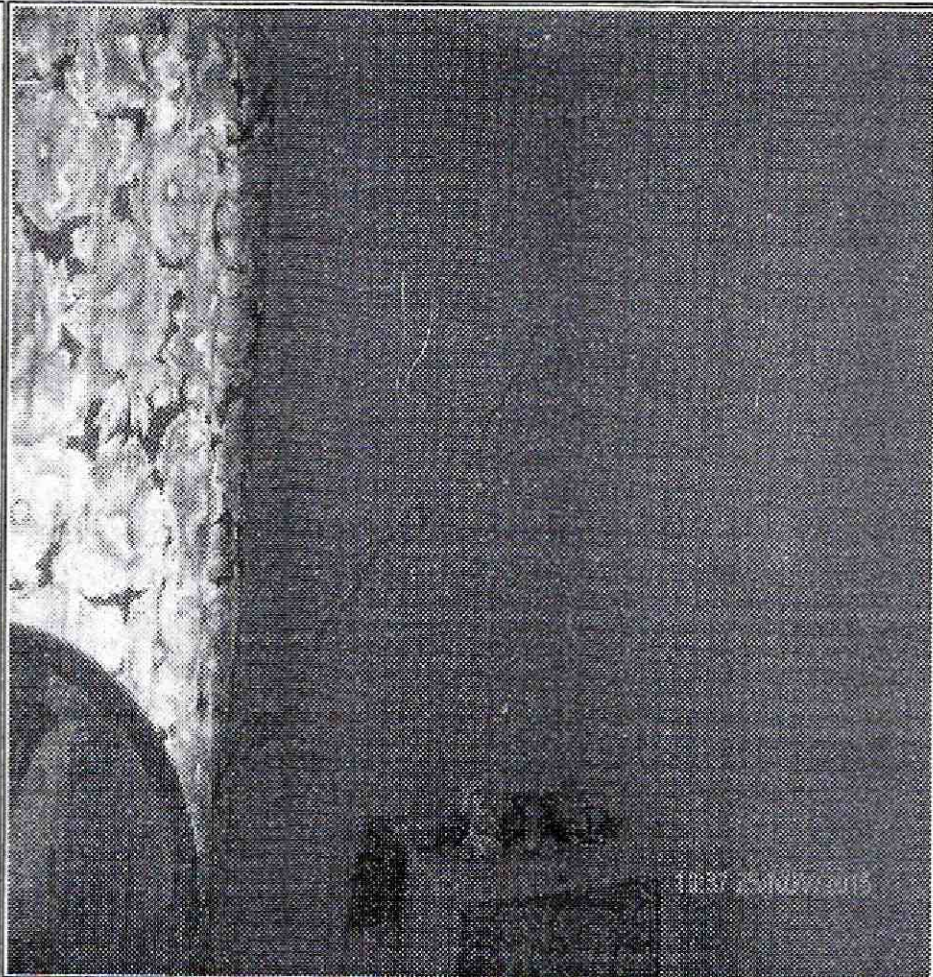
Grieta tendencia diagonal habitación segundo nivel de la vivienda
